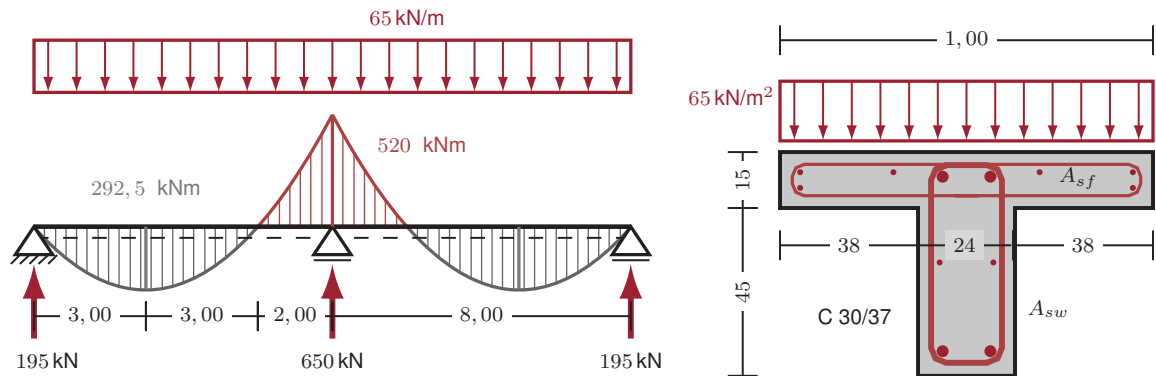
Bemessung eines 2-Feldträgers mit Plattenbalkenquerschnitt: Statisches System, Bemessungseinwirkungen mit Schnittgrößen sowie Querschnitt mit Bewehrungsskizze
